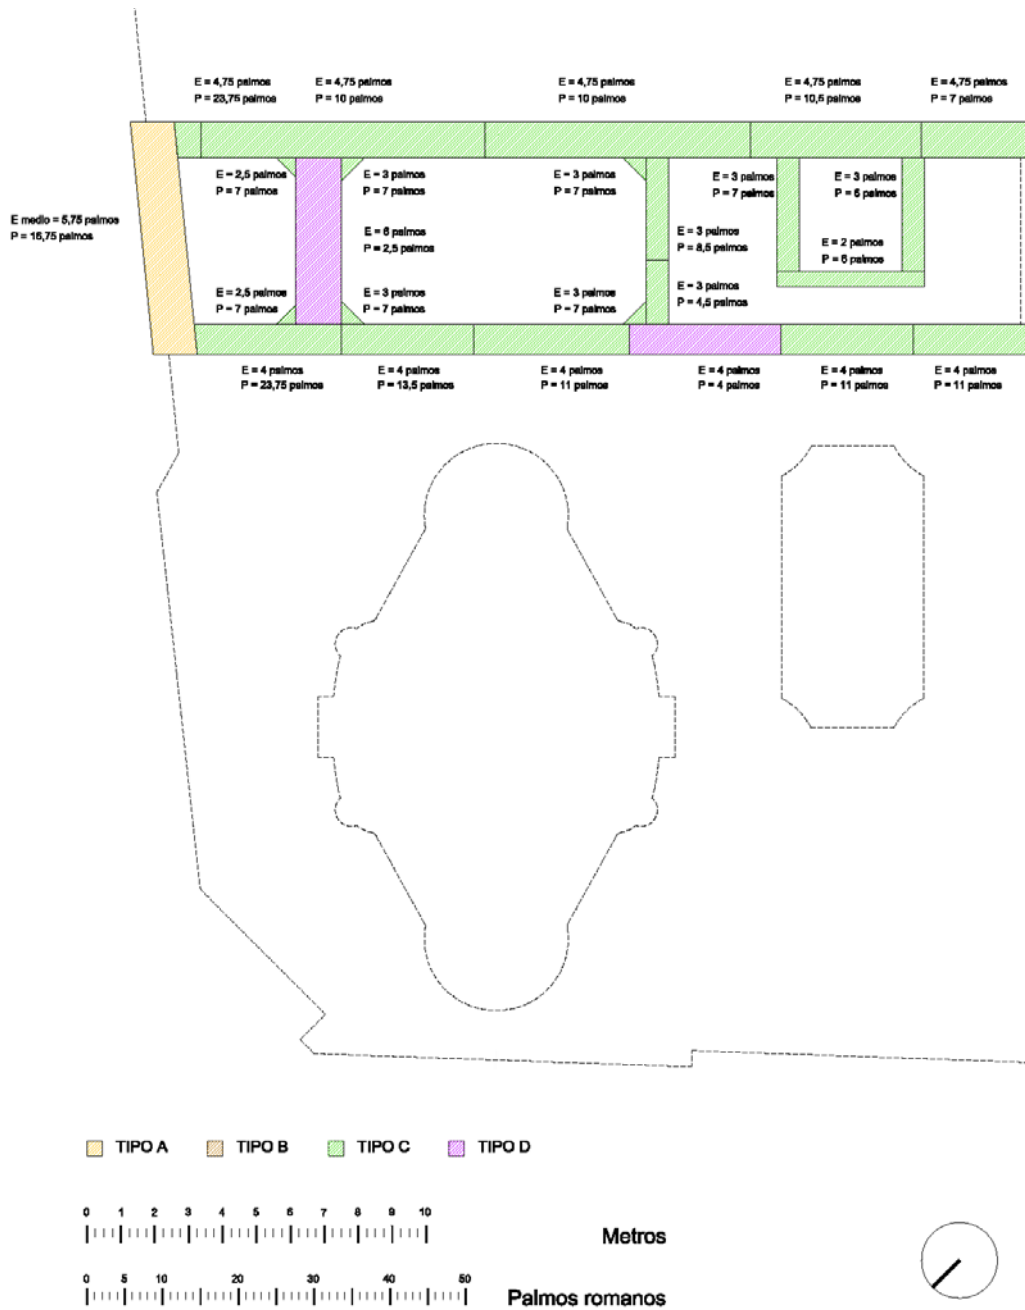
Dibujo de la autora. Planta de cimentación del cuarto del dormitorio.
